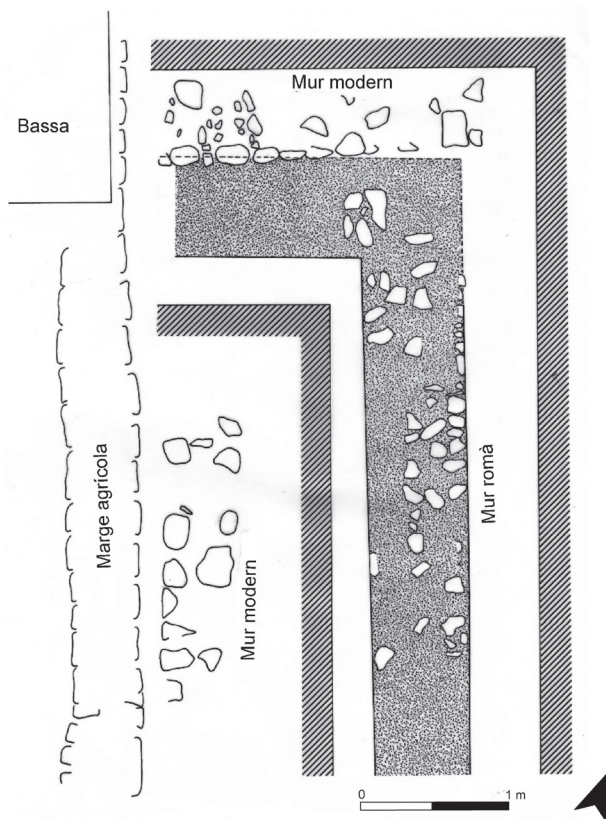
Planta dels murs trobats a l'angle NE del pati (B1).
